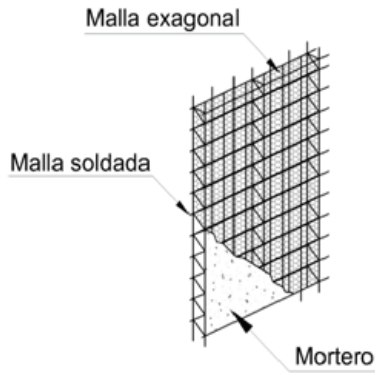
Sistema con Malla soldada con alma hueca revestido con tol expandido ó malla hexagonal para adherencia y recubierta con hormigón ó mortero
